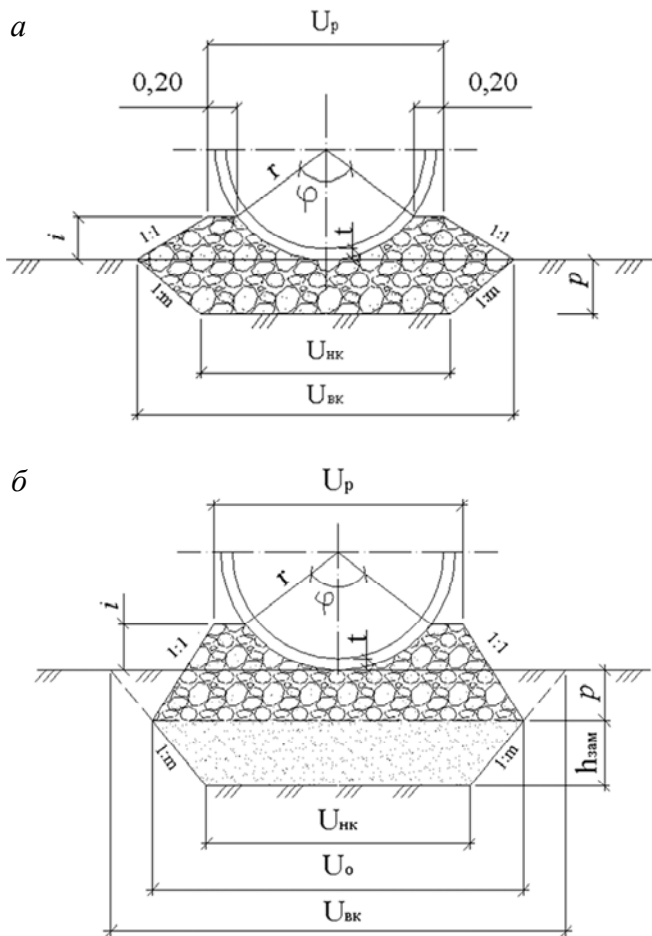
Поперечное сечение основания бесфундаментной одноочковой трубы без замены грунта под основание (а) и с заменой грунта (б)
